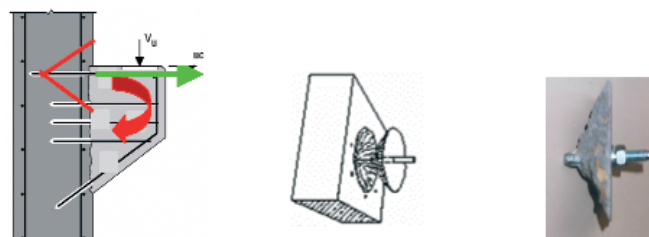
Fallo de anclaje por extracción de cono. Ej. ménsula corta
